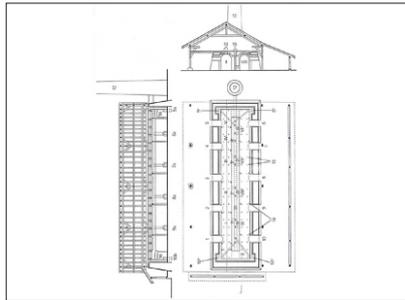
Grundriss und Schnitt eines historischen Ringofens
